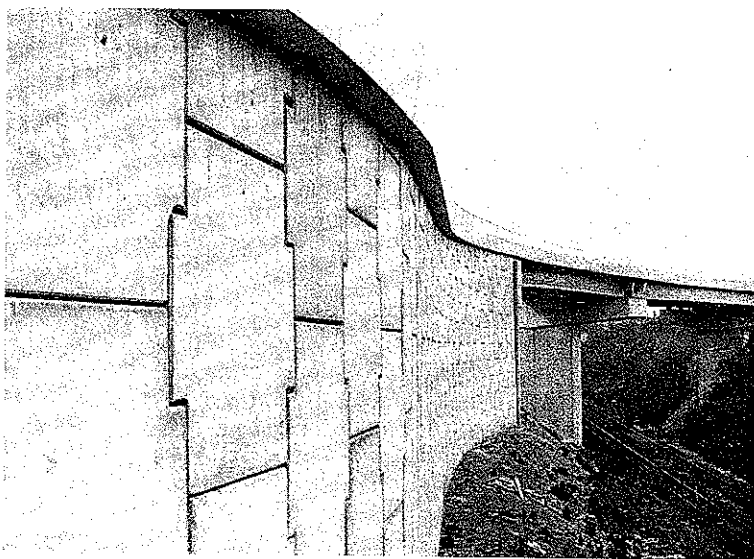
Vue d'un ouvrage à parement en écailles de béton.
